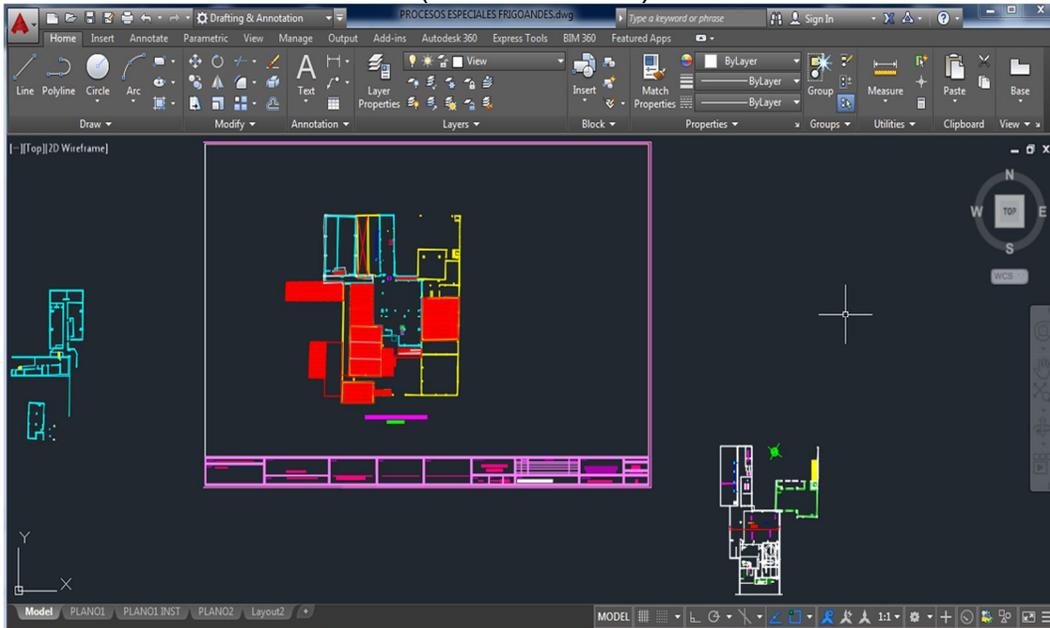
Plano Planta Nivel 2 (AutoCAD 2015)
